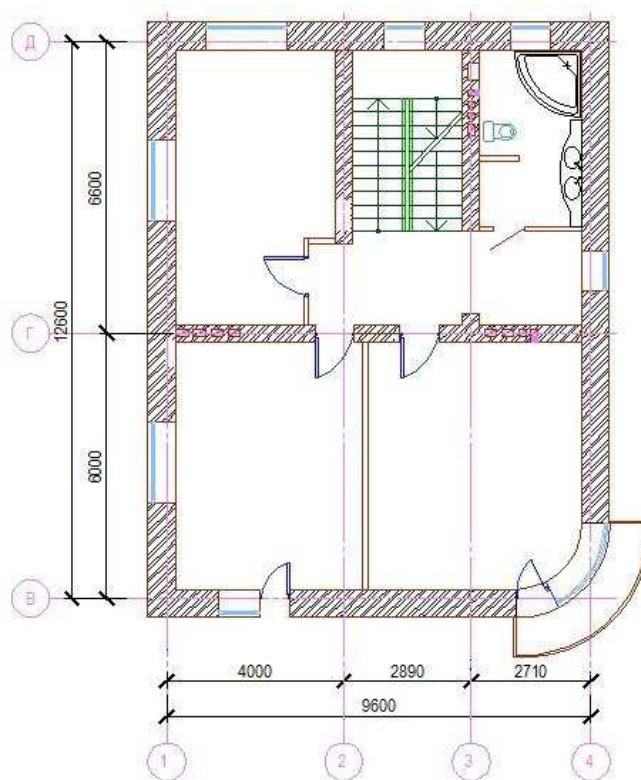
Рассматриваемый участок плиты перекрытия 2-го этажа
